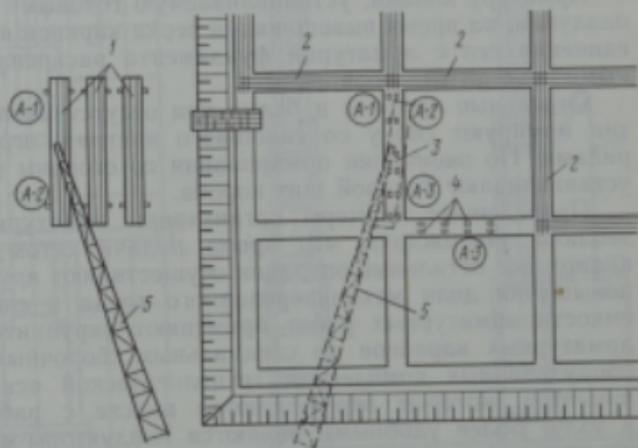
Организация установки арматурных каркасов ребристого перекрытия
